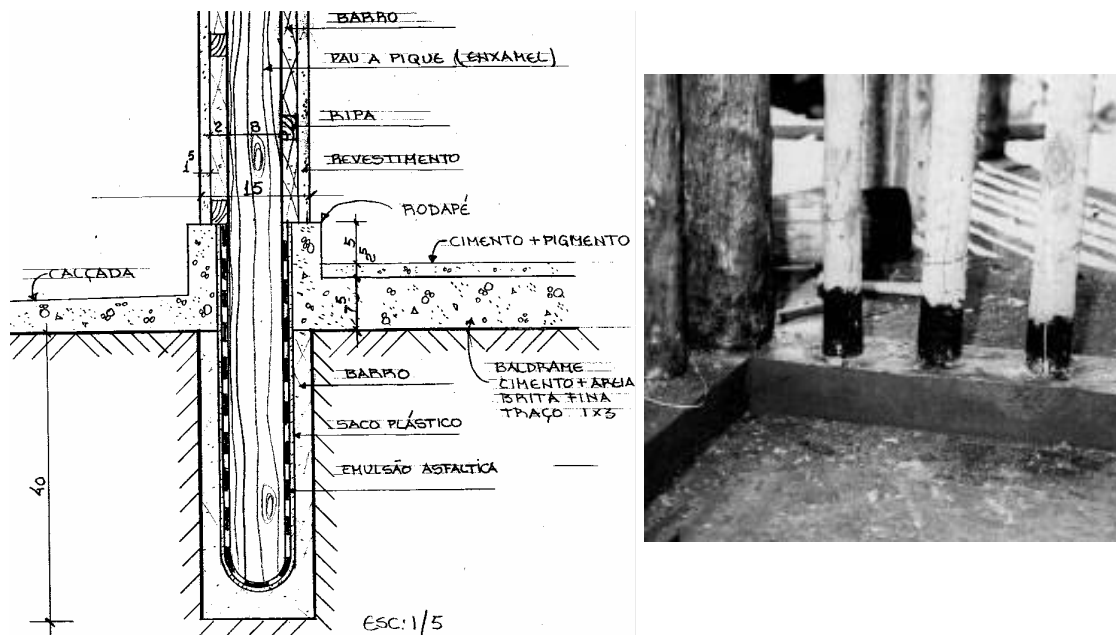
Detalhe do sistema de proteção e fixação do madeiramento, utilizado pelo arquiteto Cydno Silveira. Fonte: Lopes (1998).
